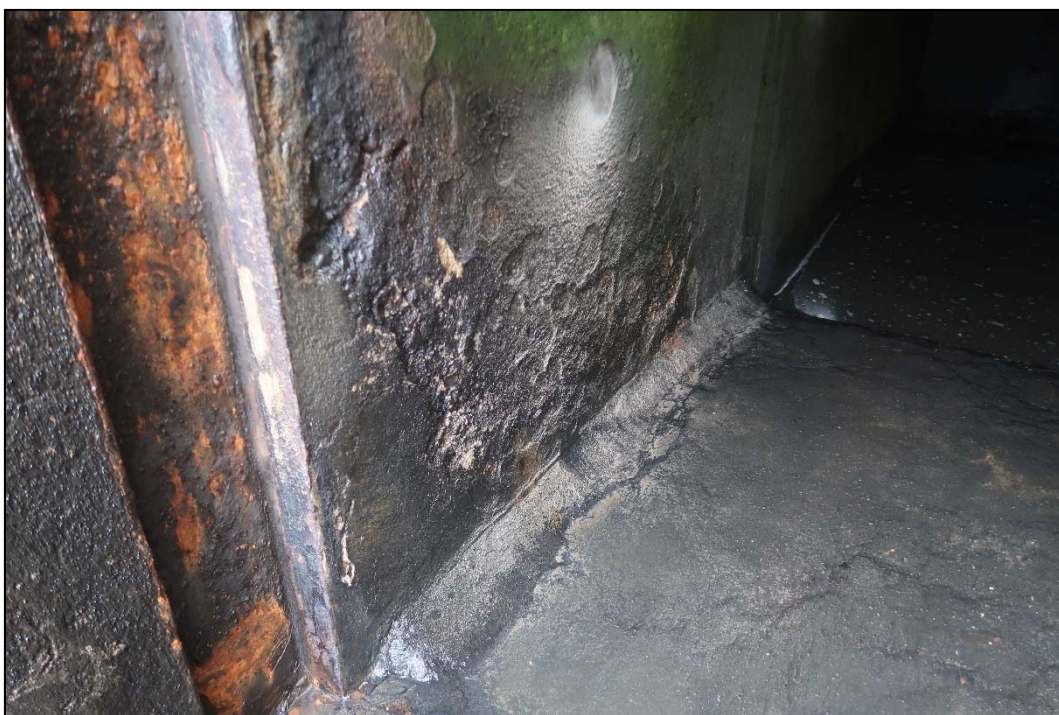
Detailní pohled na vodící lištu stavidla zasaženou korozi a degradaci povrchové vrstvy betonu zdi kašny č. 3
